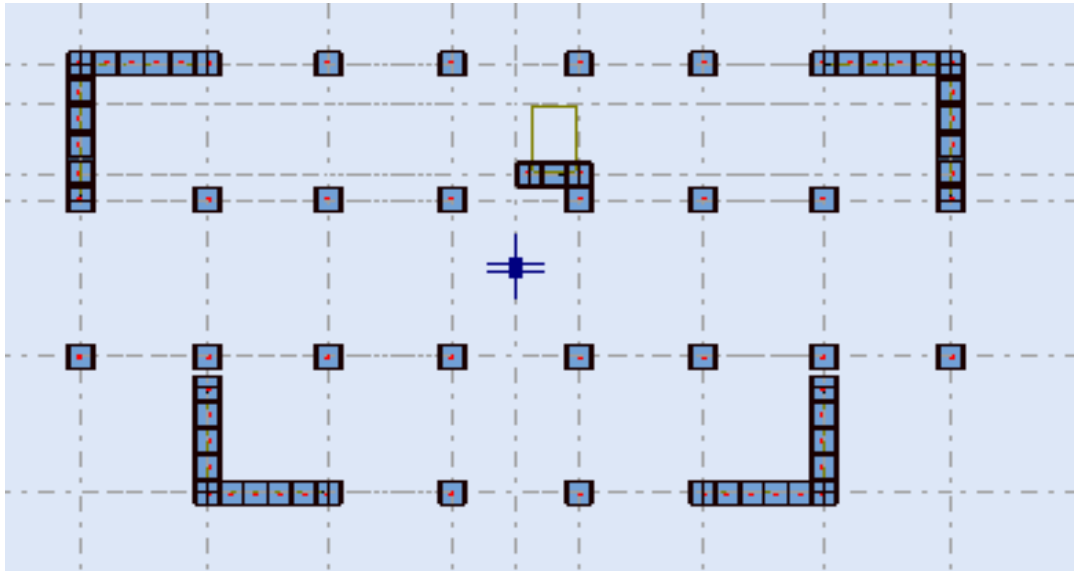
Vue en plan pour la disposition des voiles selon le plan initial
